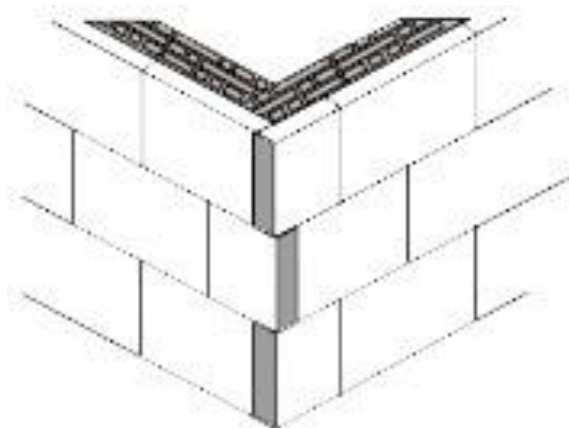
Dettaglio di posa all'angolo dell'edificio
